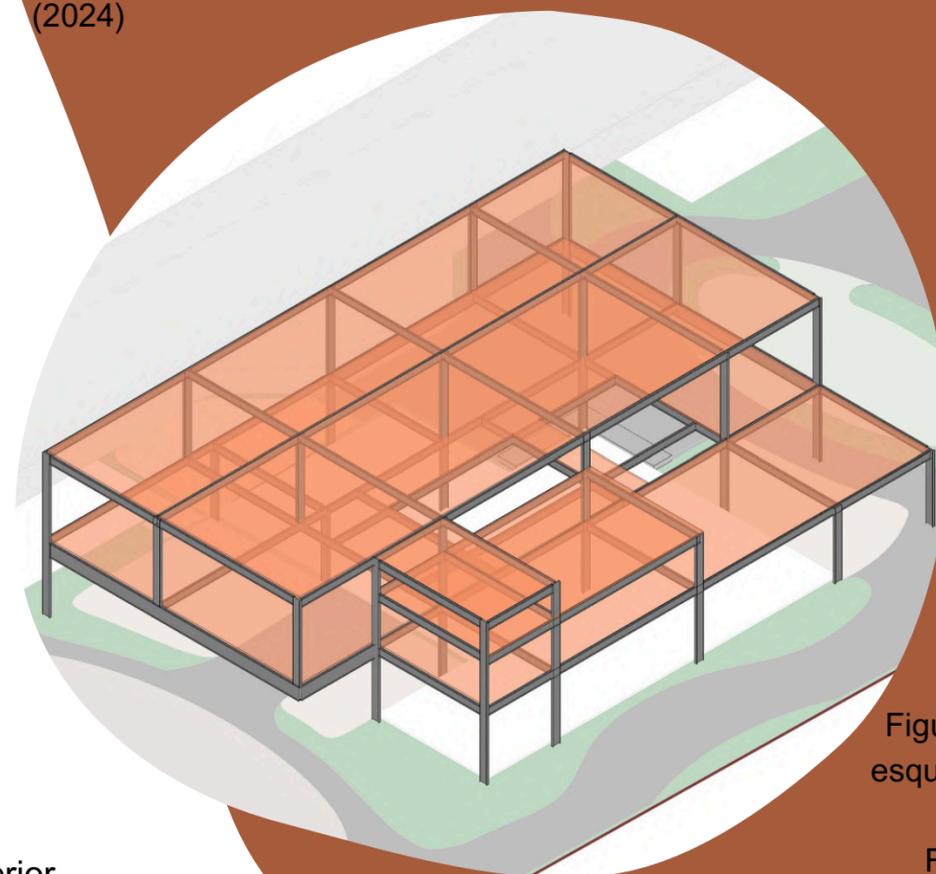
Perspectiva esquemática com pilares, vigas e lajes
